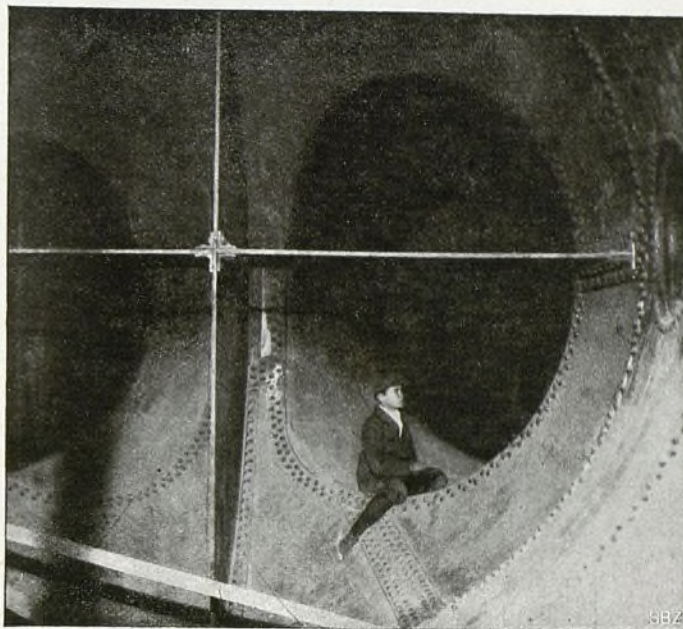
Vista interior y Fig. 31, corte horizontal de la pieza de bifurcación. Escala 1 : 60. A, Platins de empalme para las tuberías de desagüe. B, Plancha de refuerzo horizontal. C, Cruz de refuerzo.
